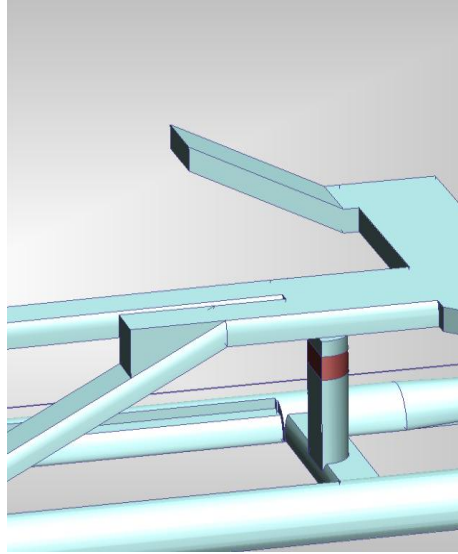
Beton olarak tanımlanan hacimler
